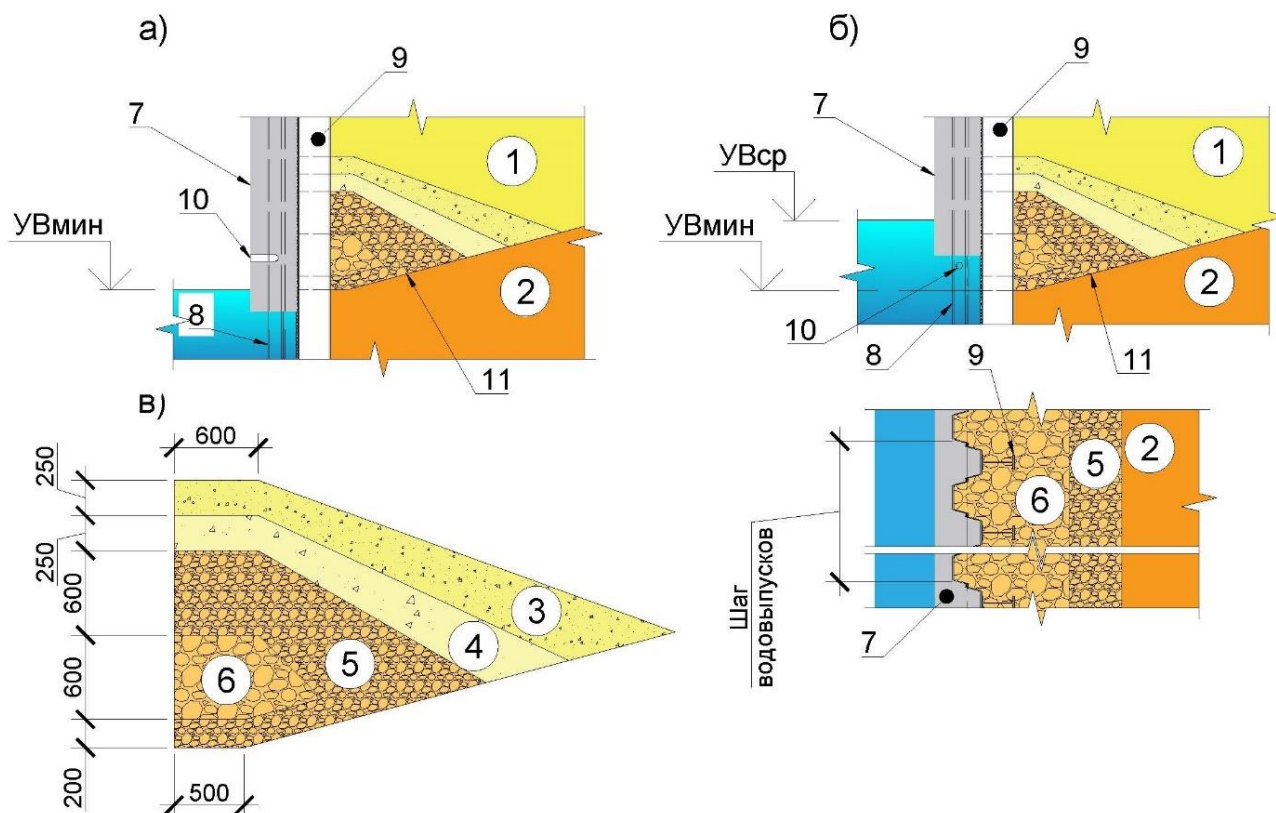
Схемы дренажных устройств: а – водовыпуск через оголовок; б – водовыпуск через корыто шпунта; в – конструкция дренажной призмы; 1 – грунт засыпки; 2 – грунт основания; 3 – среднезернистый песок; 4 – гравелистый песок; 5 – щебень из смеси фракций 40+70 мм – 30 %; 3+10 мм – 40 %; 6 – камень 15+20 мм; 7 – железобетонный оголовок; 8 – корытный шпунт; 9 – усиливающая балка; 10 – водовыпуск; 11 – дренажная призма
